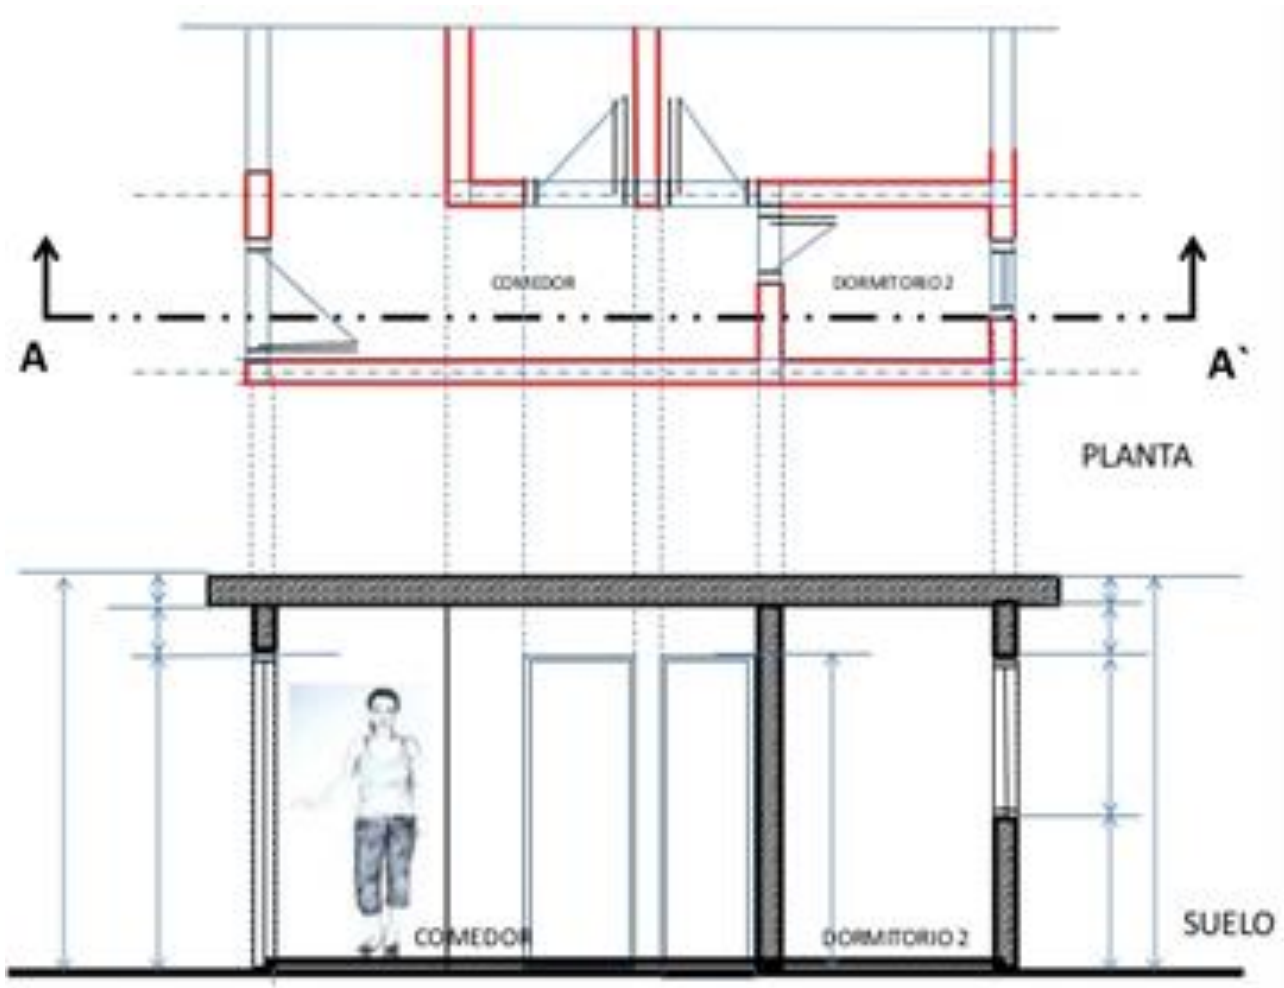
El eje A-A' en la planta arquitectónica, indica por donde pasa el corte y las flechas señalan el lado que se observa en el corte
